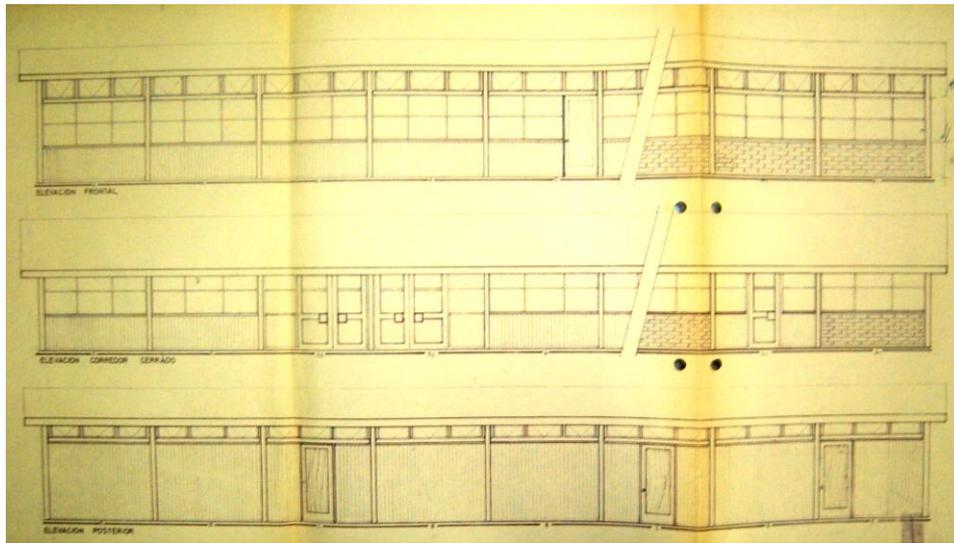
Planta, corte y elevación, administración, proyecto Original, 1959
